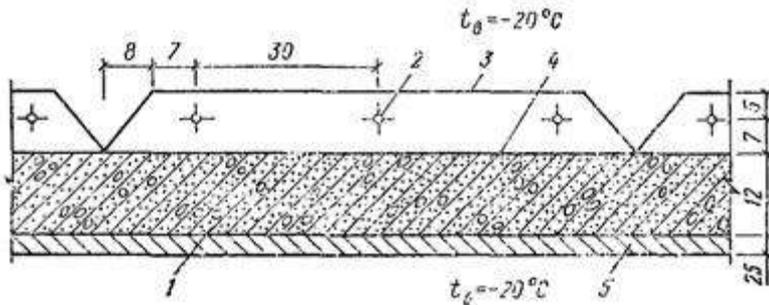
Схема к расчету и конструированию инфракрасной установки для обогрева плиты перекрытия
